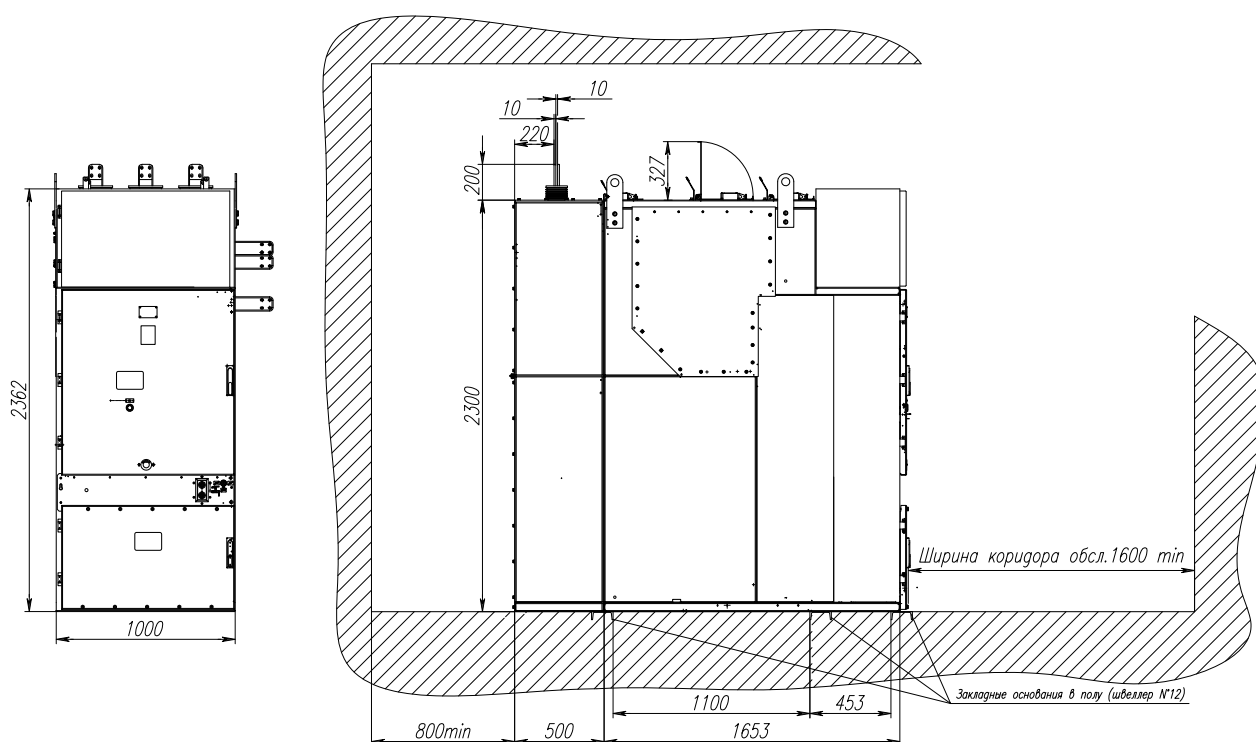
Общий вид и габаритные размеры КРУ К-131 шинного ввода на номинальные токи 2000-2500 А
